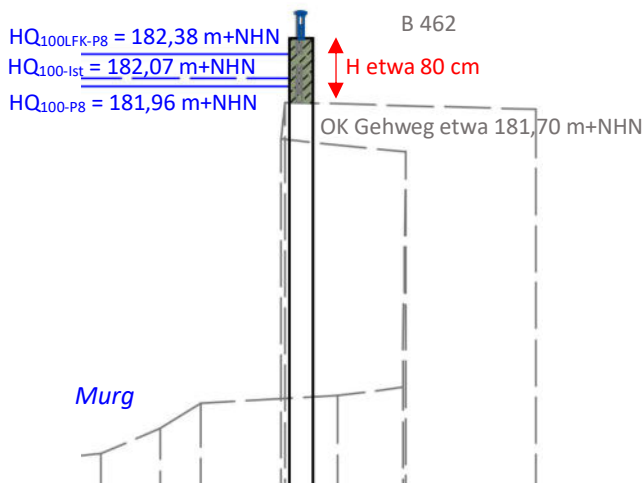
Herstellung Betonbrüstung mit aufgesetztem Handlauf auf dem auskragenden Gehweg, Station km 29+675
